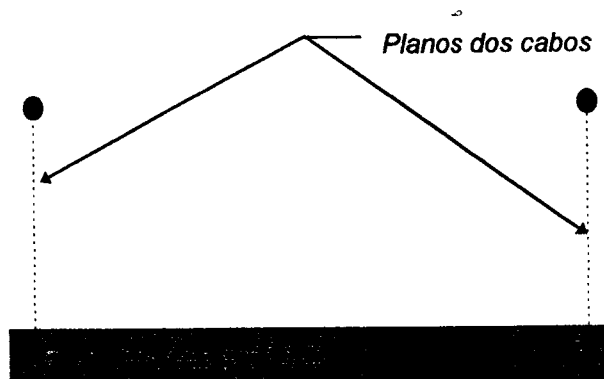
Sistema com dois planos verticais contendo cabos paralelos longitudinais.
